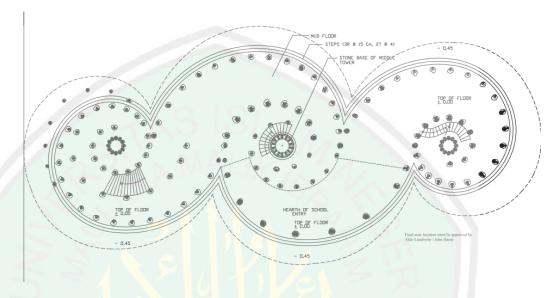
Heart of School site Plan, Green school (sumber: Shim, 2010: 22)
